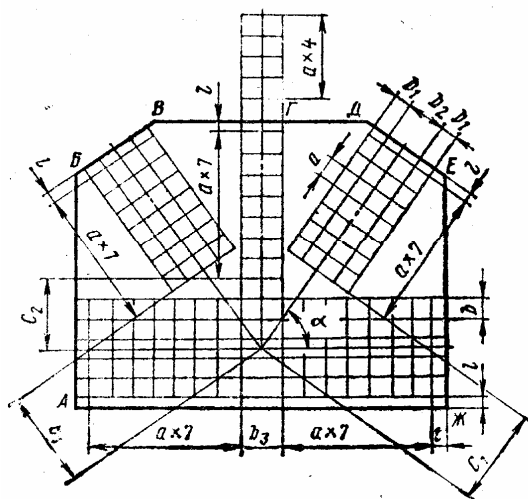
Схема расположения отверстий для монтажных болтов на узлом фасонном элементе
